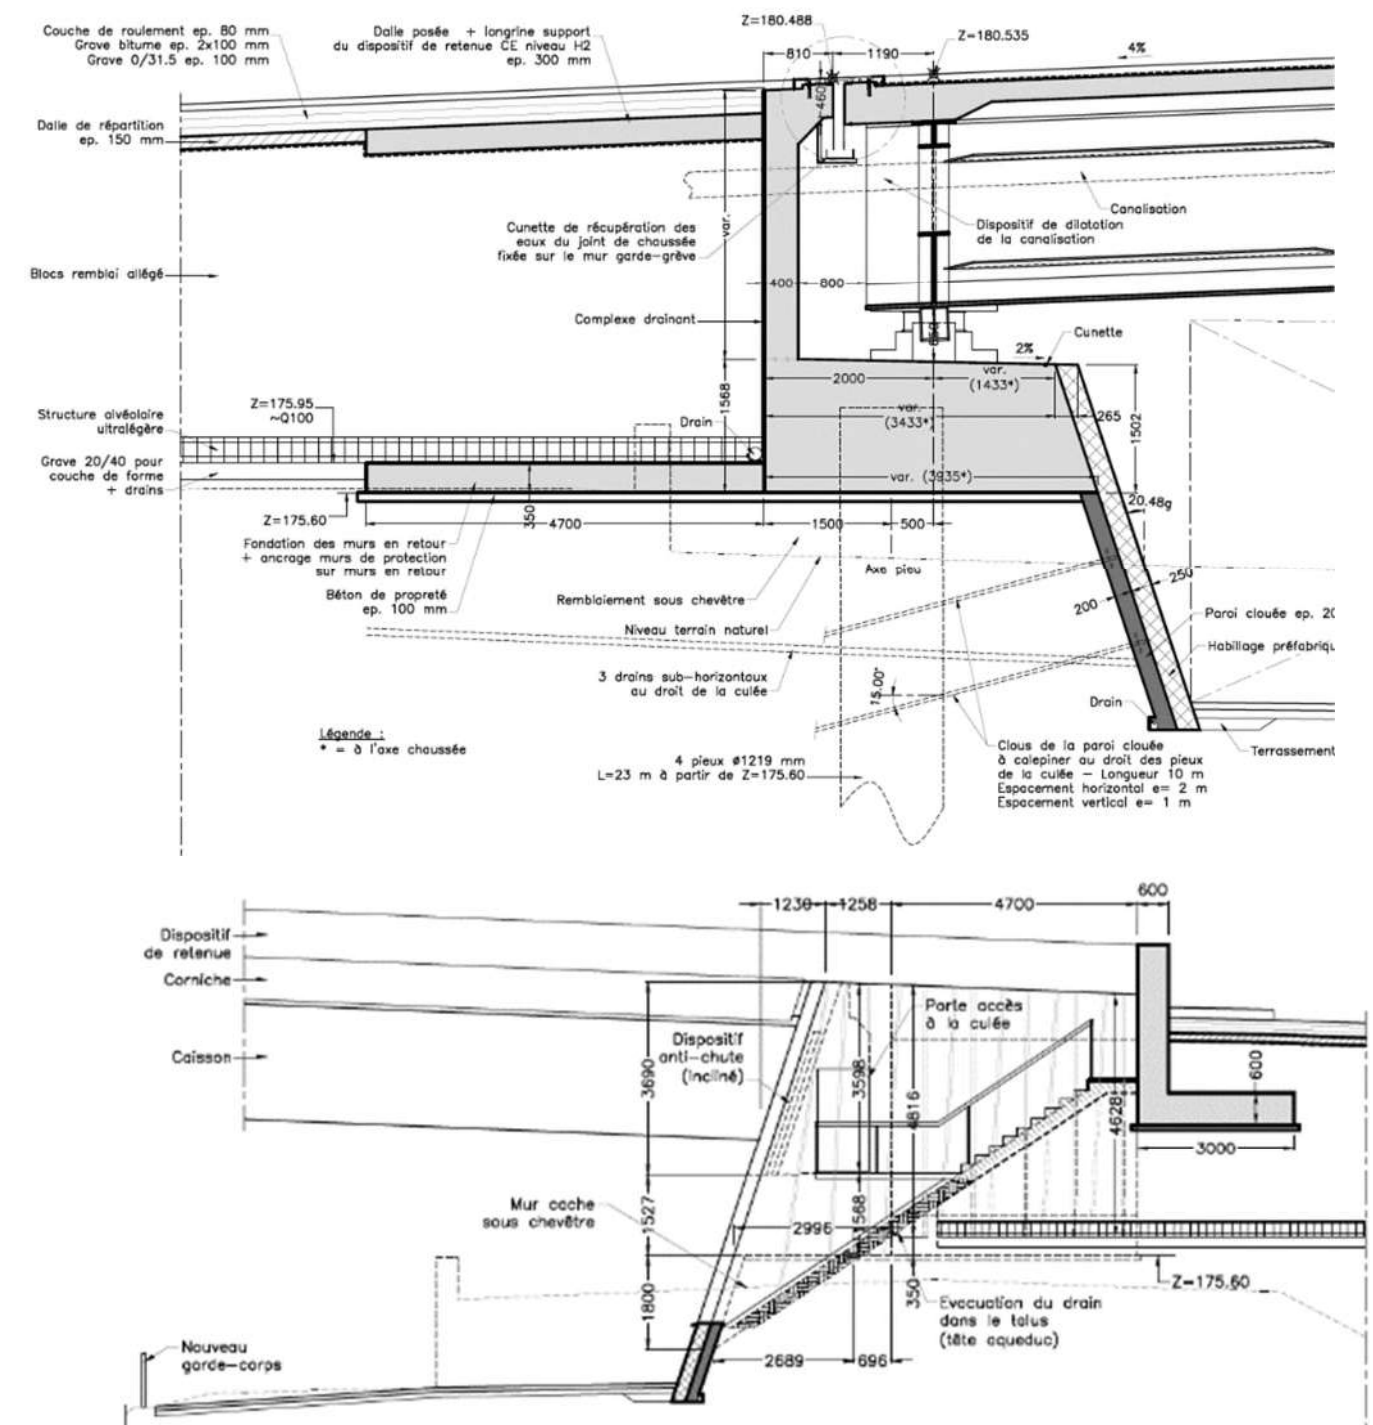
Coupe longitudinale sur culée C0 à l'axe de l'ouvrage et sur mur amont
